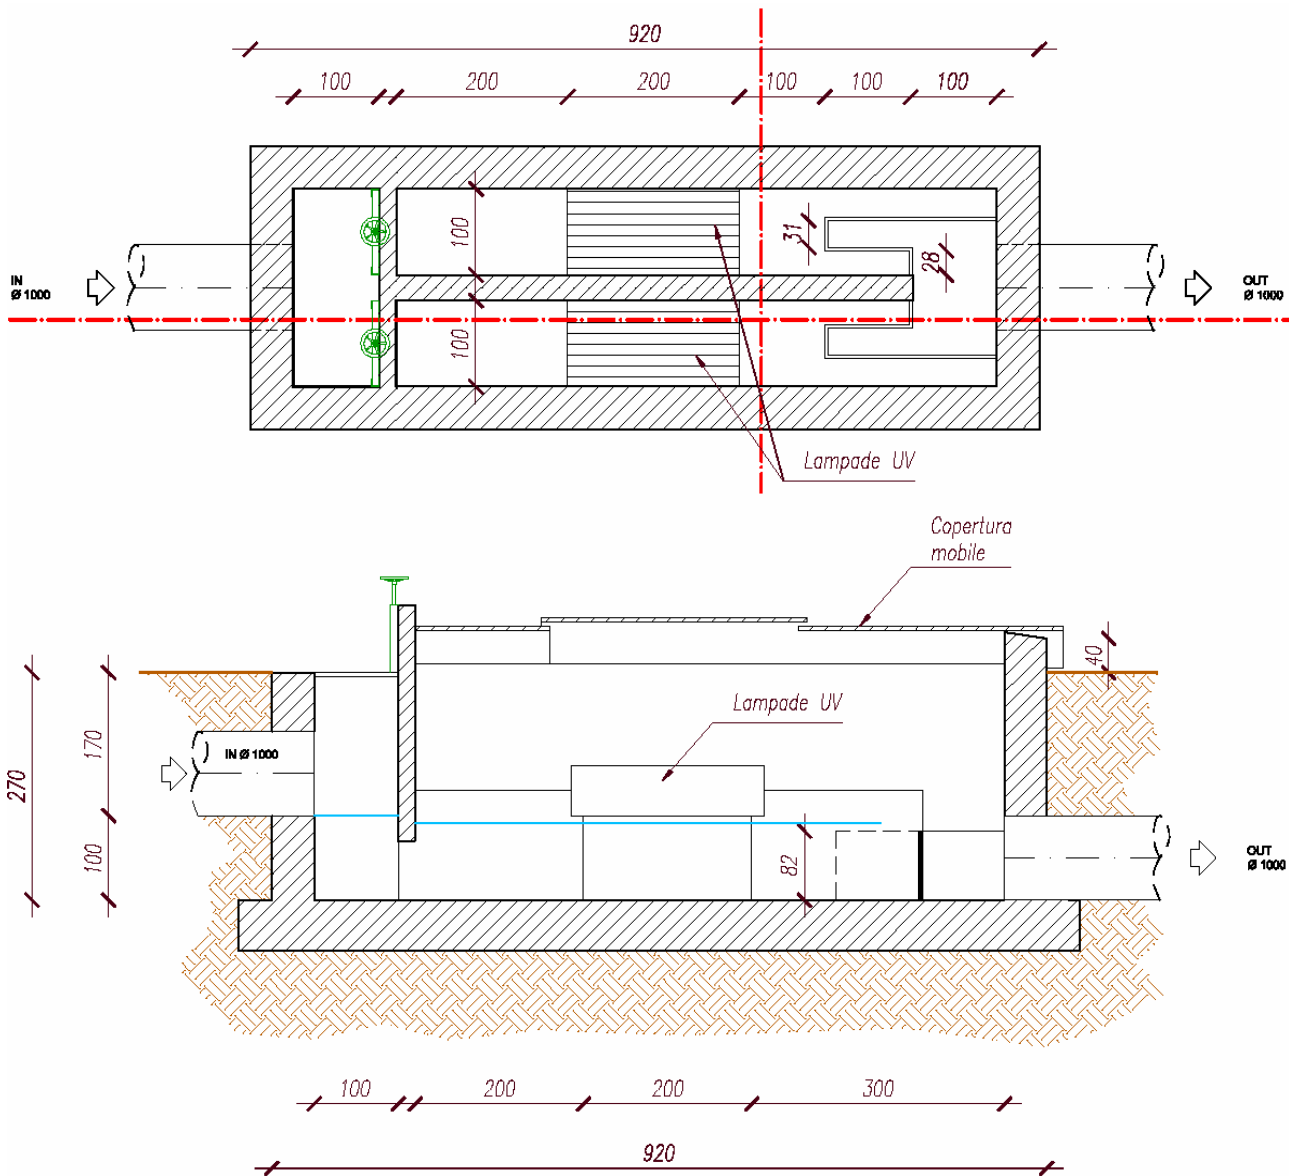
Opere in progetto: Impianto di disinfezione a raggi UV (pianta e sezione).
